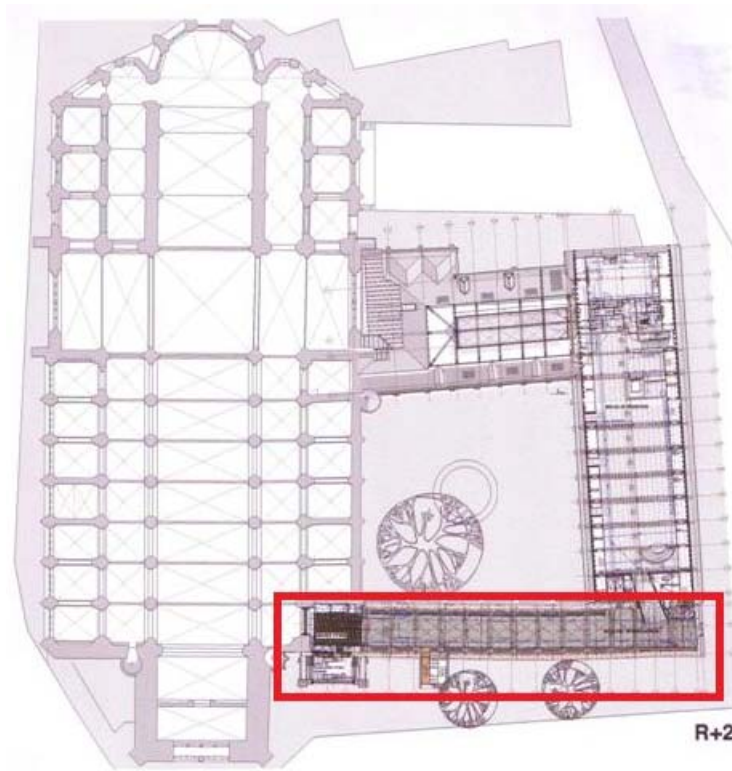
Plan correspondant aux ailes du cloître, en rouge l'aile Ouest (Janssen, 2009)
